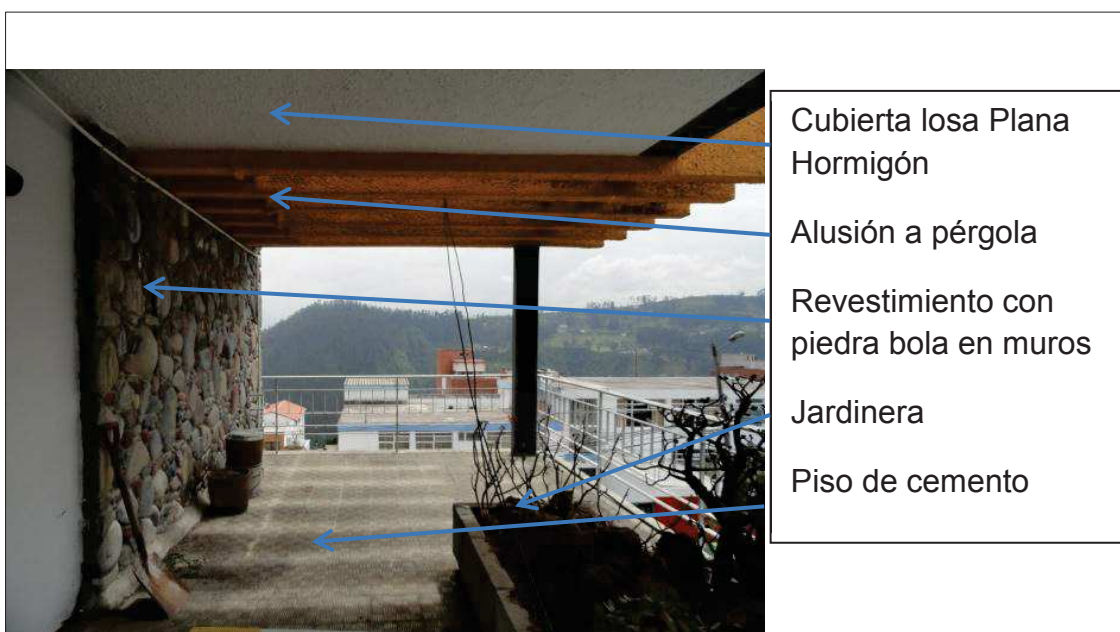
Vista Exterior Ingreso y Planta Alta de edificación.
